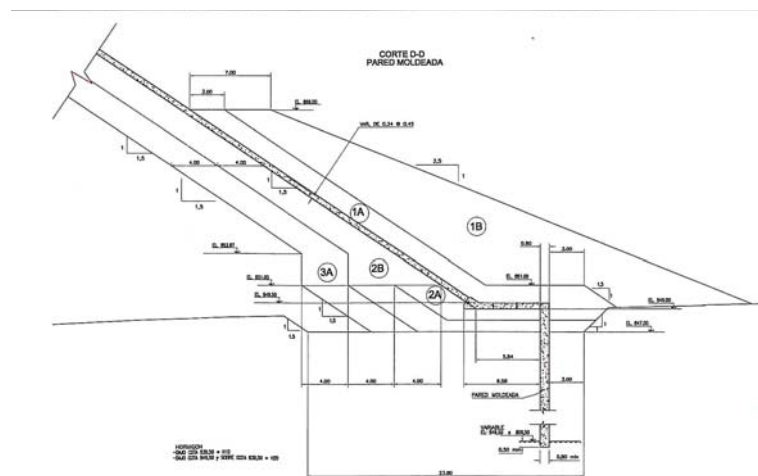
Disposición de rellenos en pie de presa sobre aluvial permeable
